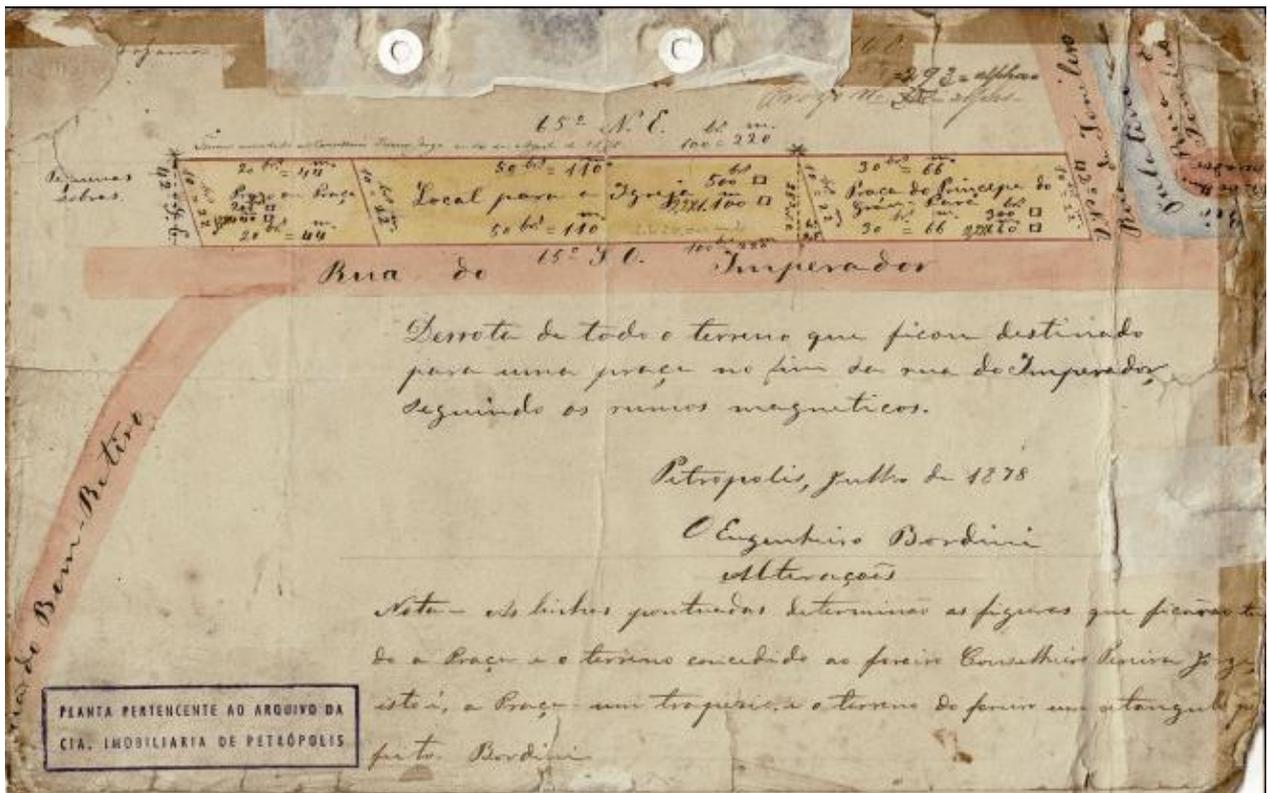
Planta baixa do terreno adquirido pela Irmandade do Rosário e de São Benedito, em 1878.
